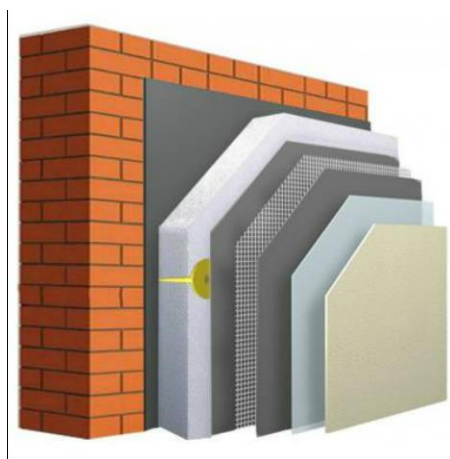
Технологія утеплення фасаду будівлі
